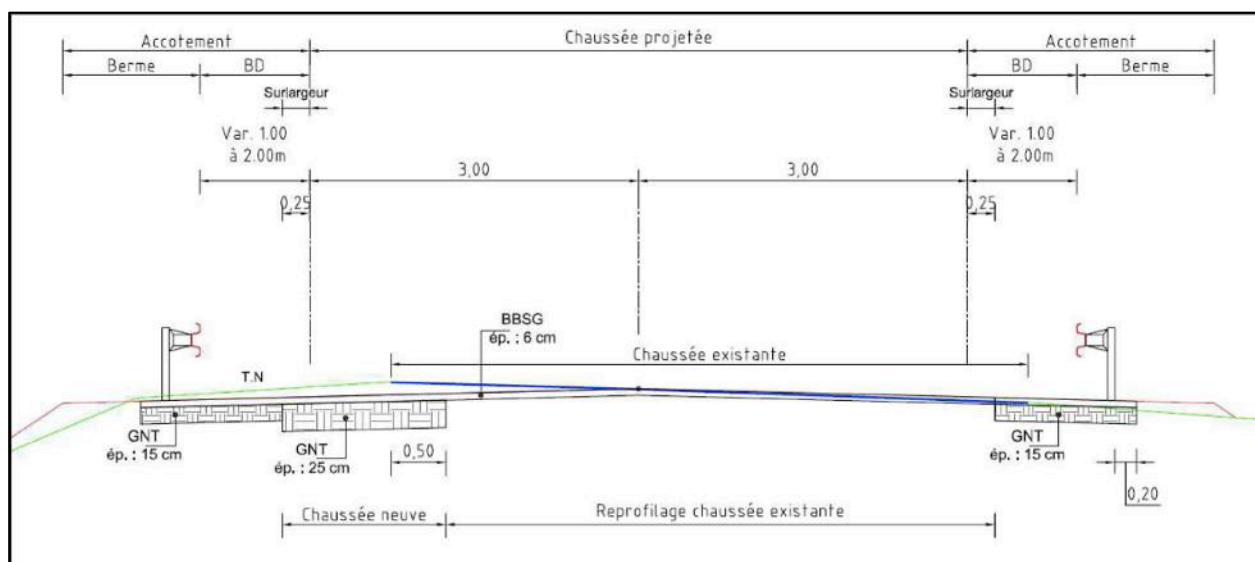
vue en travers de la structure de la chaussée (source : DEPS, 2016).
